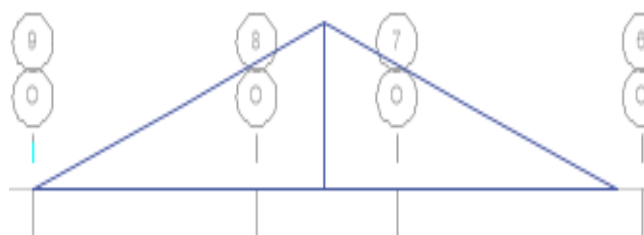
Cercha de tipo pendolón en madera. Fuente: Autor
